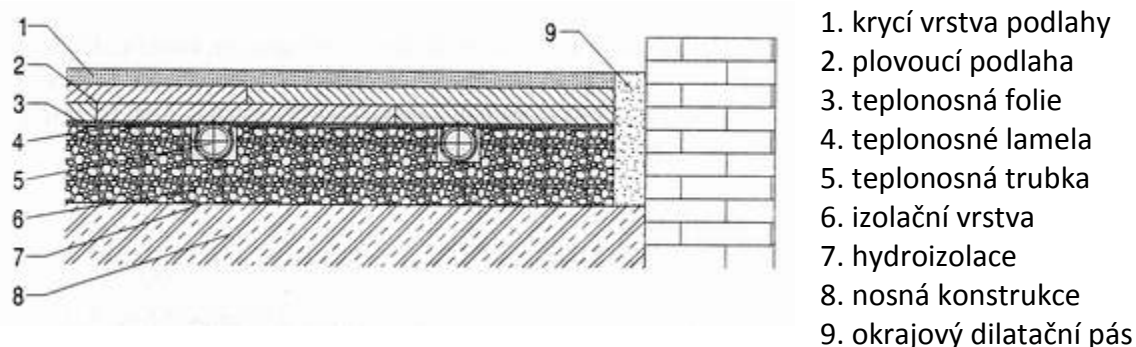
Mokrý způsob provedení – systémová deska [3]
